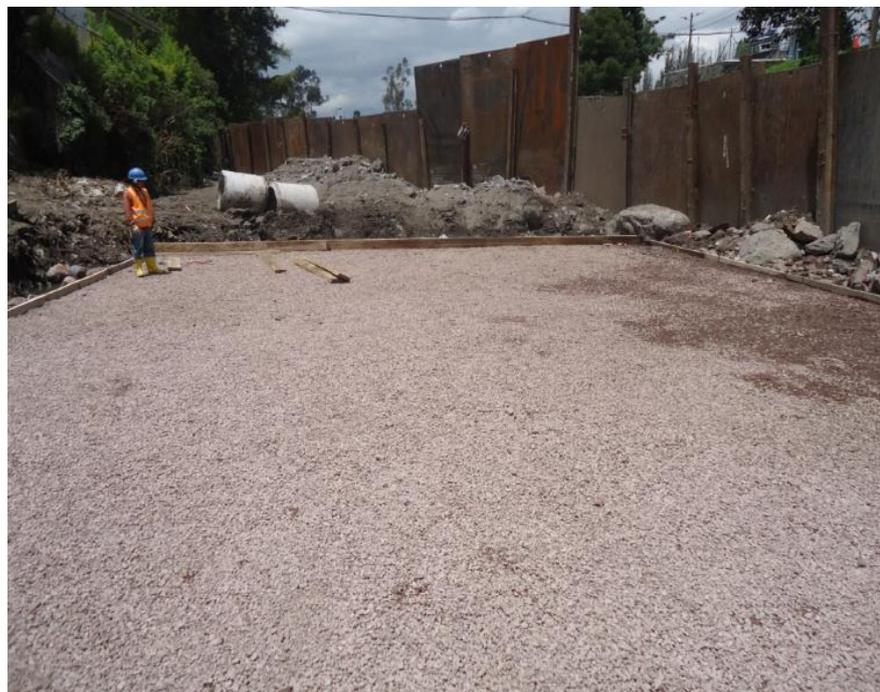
Mejoramiento del suelo para fundir losa de cimentación I
